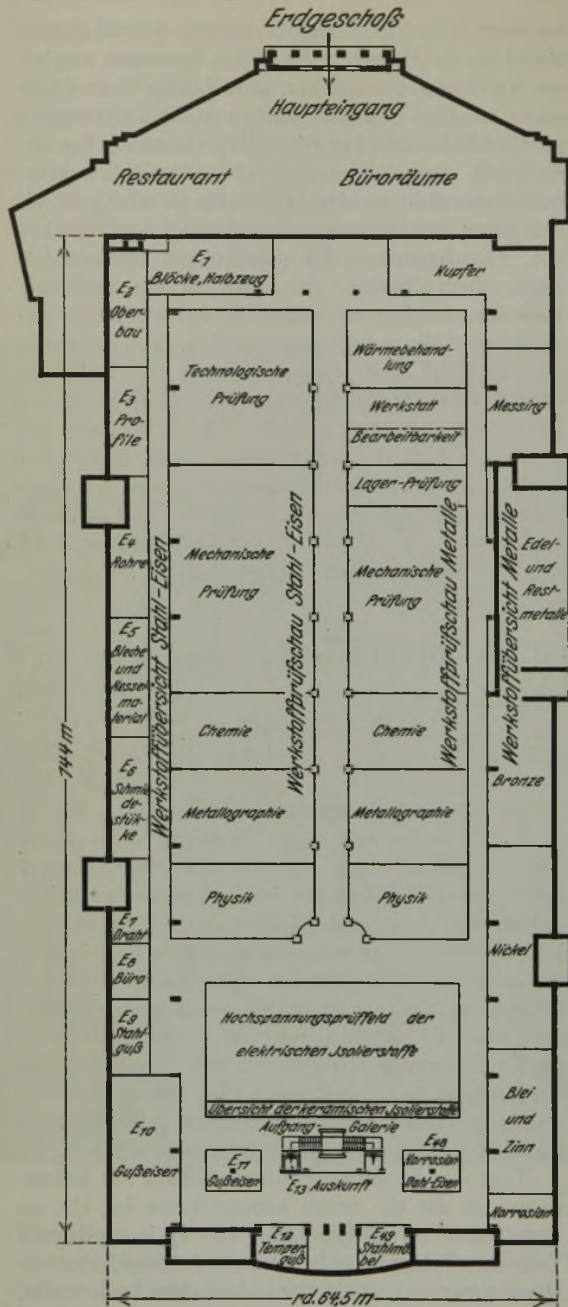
Grundplan der Werkstoffschau (Erdgeschoß).
